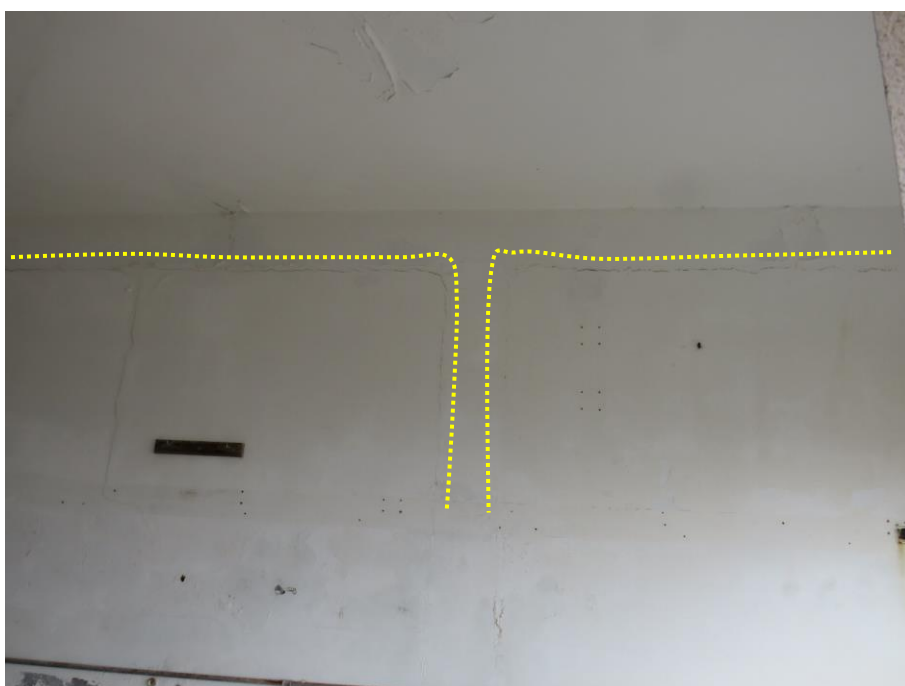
Fissuração entre os elementos estruturais (vigas e pilares) e a parede de alvenaria.
